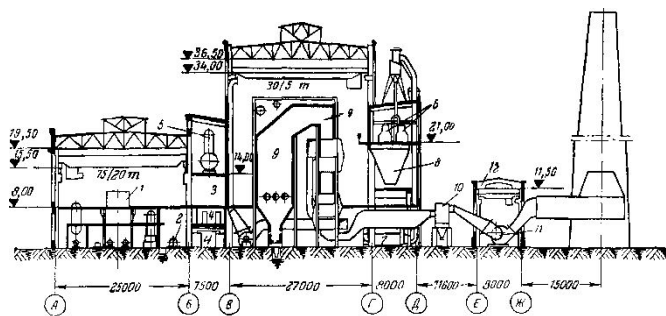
Главный корпус Экибастузской ГРЭС-1. Разрез.
